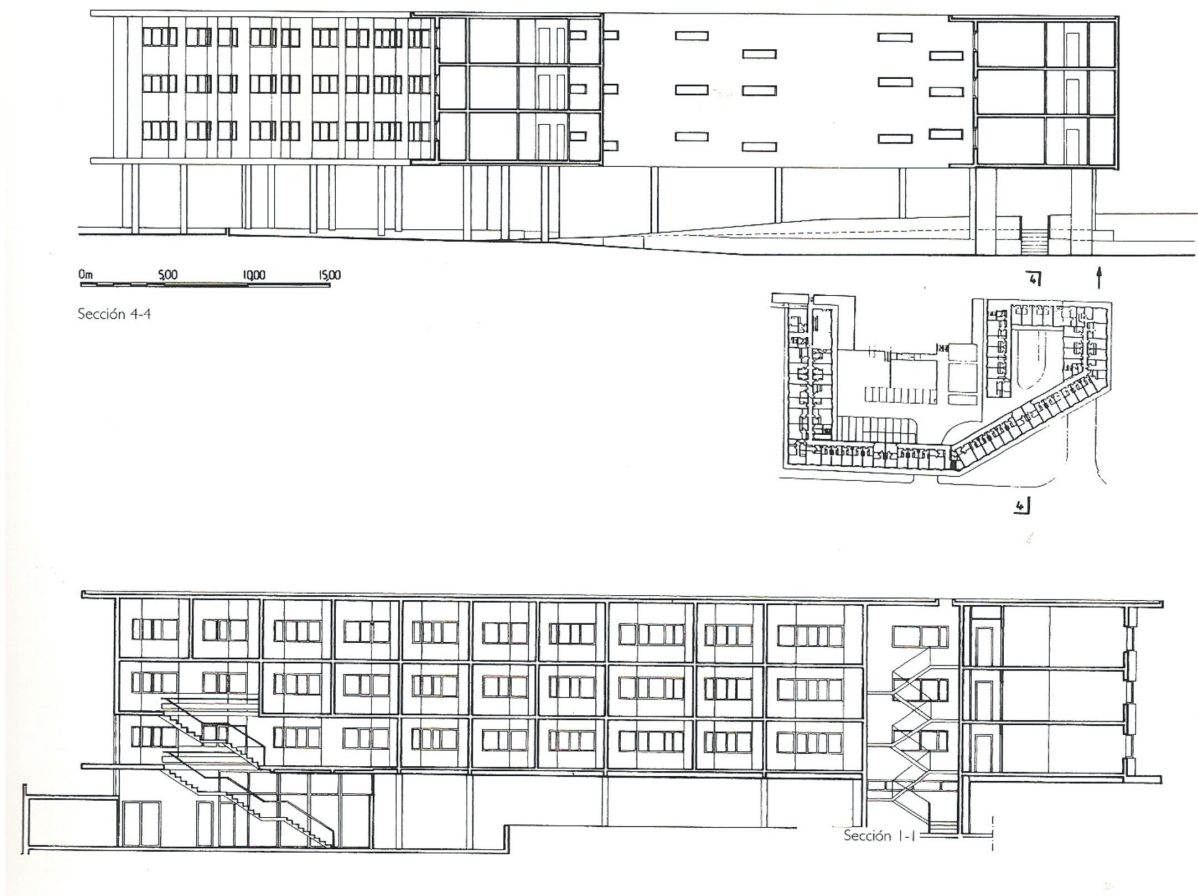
Corte e fachada.(HUBER, Wilhelm)
